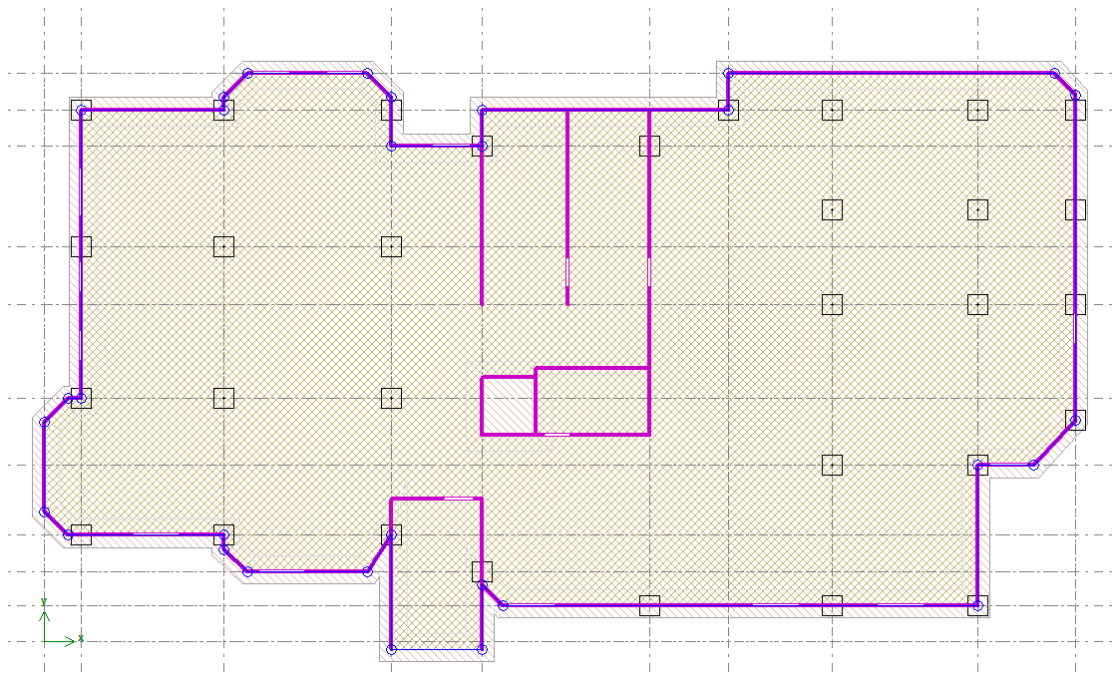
Розрахункова схема для цокольного поверху житлової будівлі
